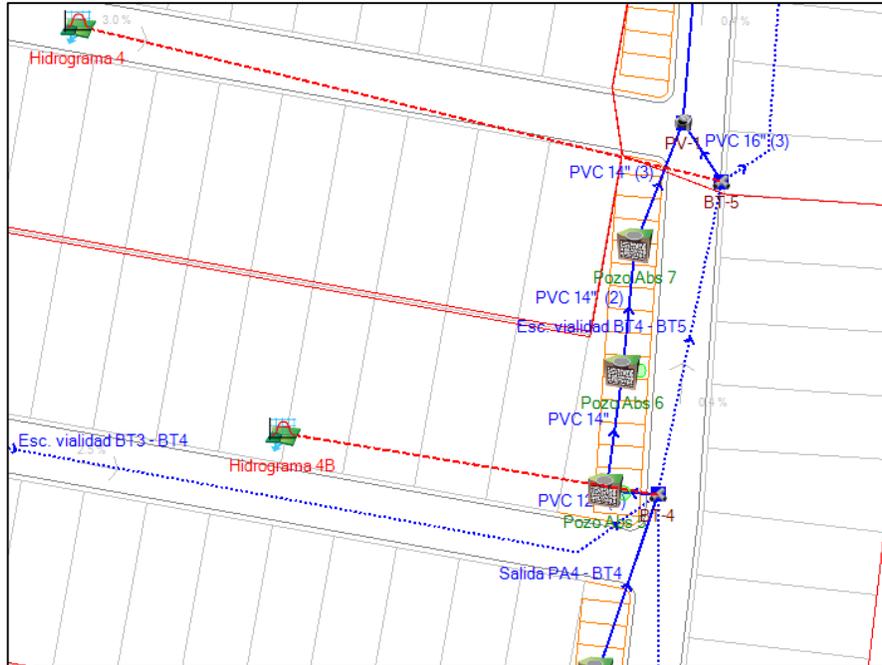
Vista en planta de los pozos de infiltración 5,6 y 7. Fuente: xpdrainage.
